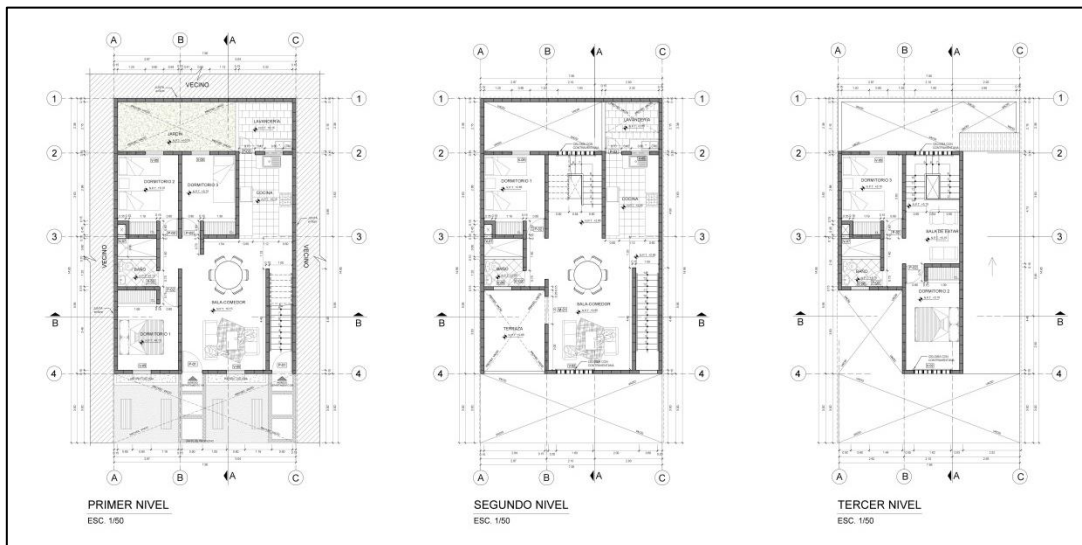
Vivienda bifamiliar entre lotes
